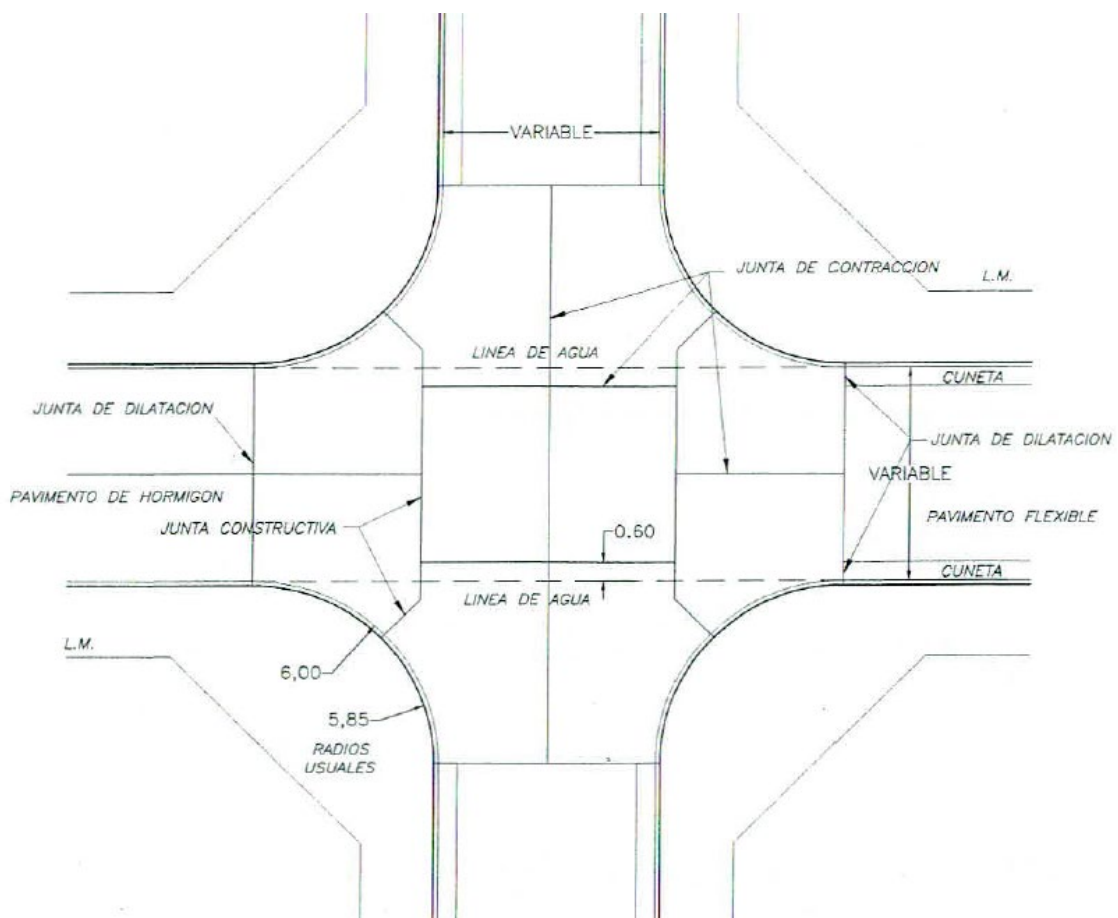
Esquema Bocacalle tipo. – Fuente: Pliego técnico.
